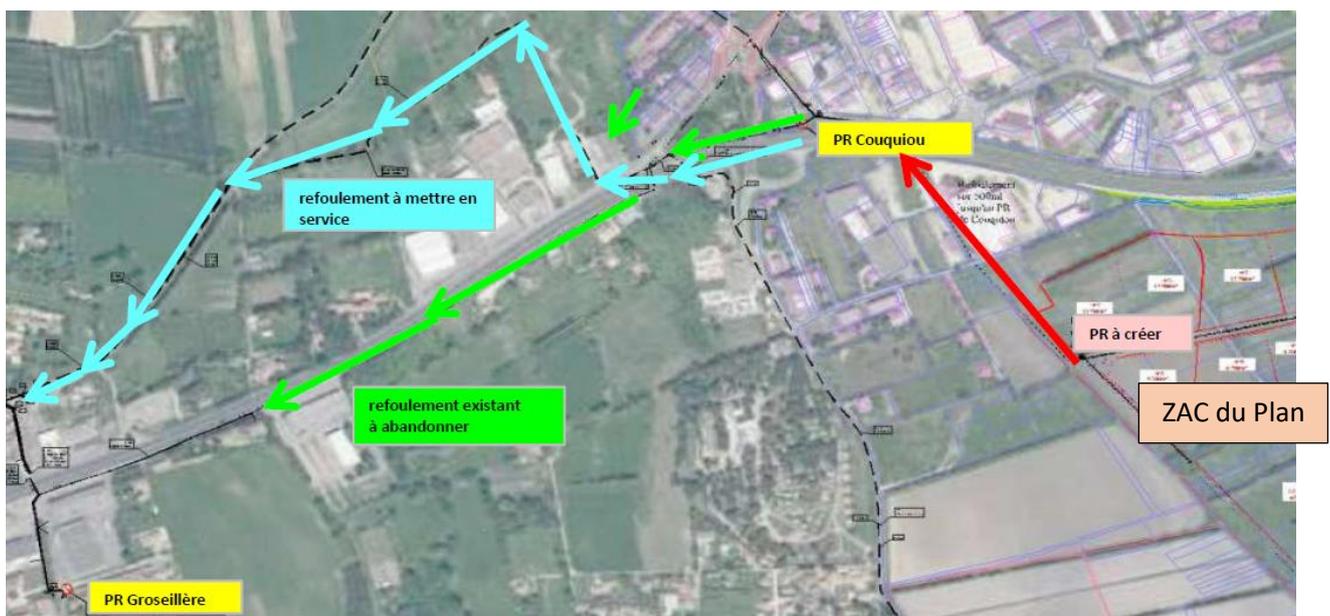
Projet de raccordement de la ZAC du Plan au réseau du SITTEU (Source : BET CERRETTI, 2020)
